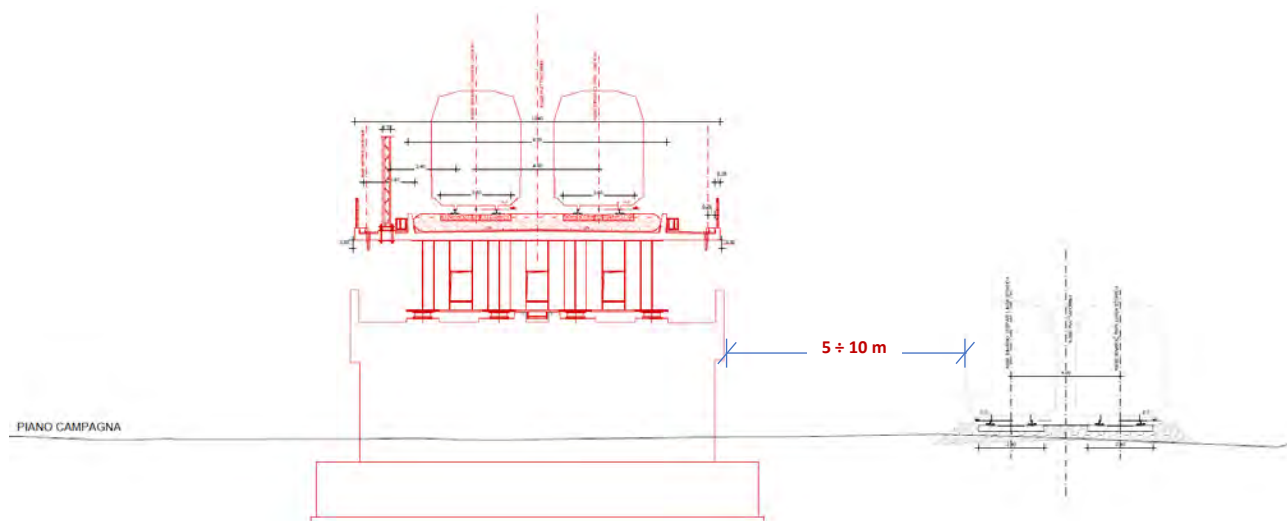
Sezione tipo – Configurazione con linea AV/AC in viadotto
